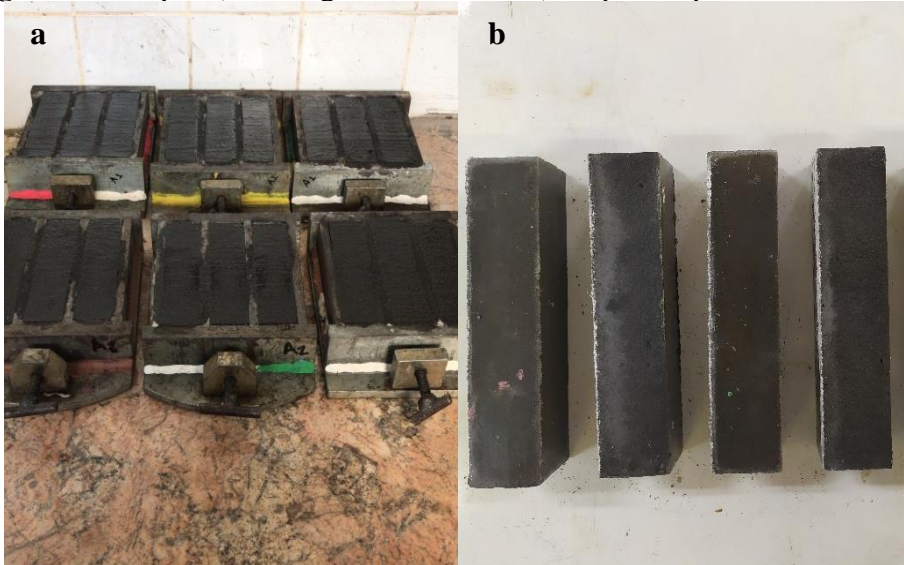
Etapas da moldagem: a) fôrma prismática; b) moldagem.
